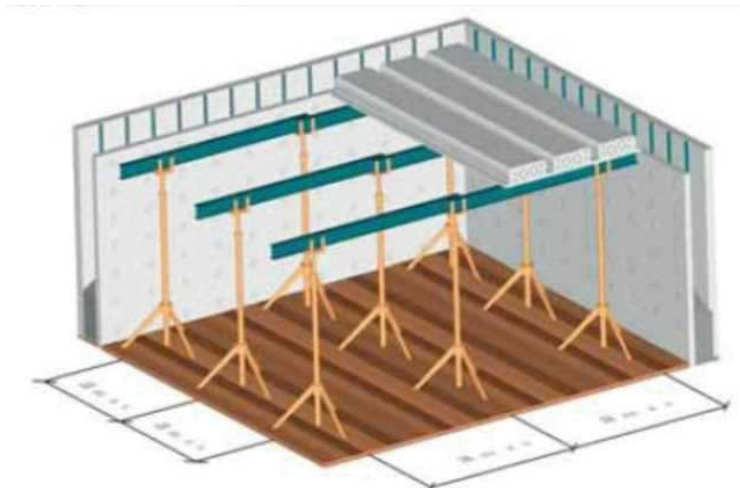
Схема размещения стоек опорных балок элементов опалубки перекрытия.
